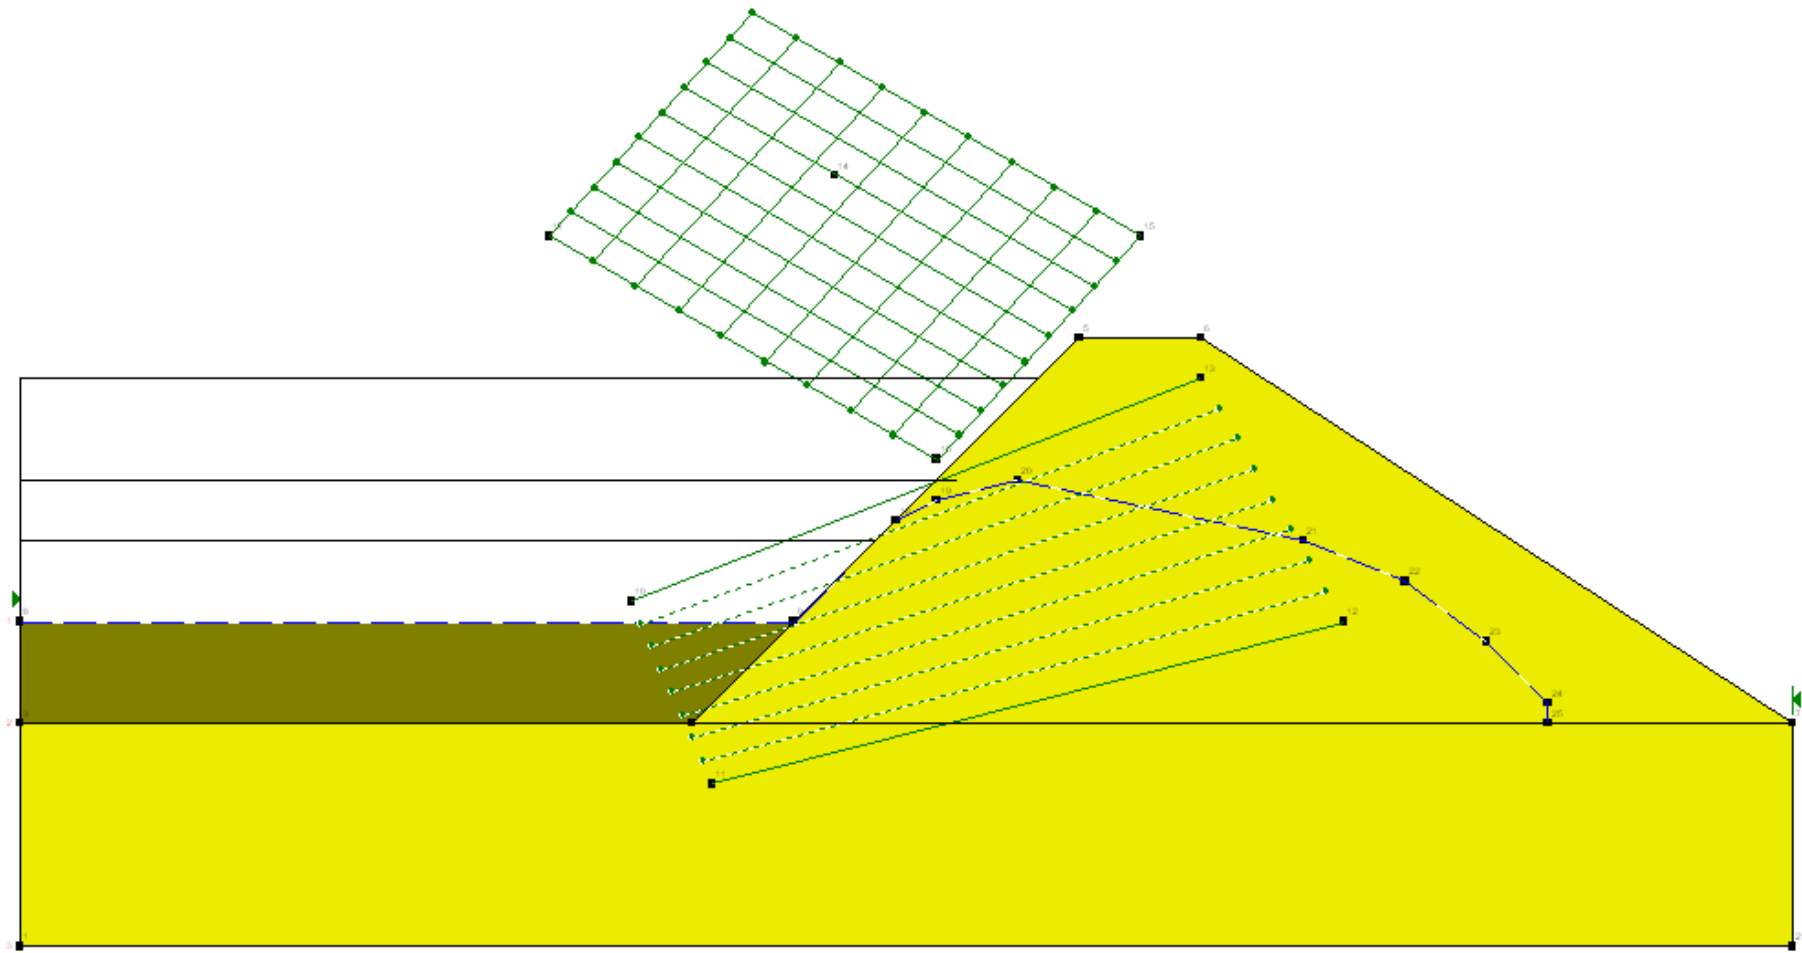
Modelo de cálculo con la presa en su estado inicial. 3ª tongada
